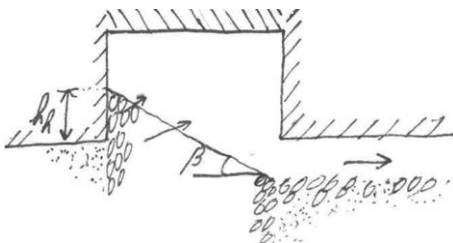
Uitspoeling van bovendeeel barrière aansluitend op benedenstroomse pipe tot ongeveer een hellingshoek gelijk aan de hoek van inwendige wrijving. De geschetste situatie betreft een relatief brede barrière met een relatief lage inkassing (zijaanzicht met enige 3D-suggestie in langsrichting).
